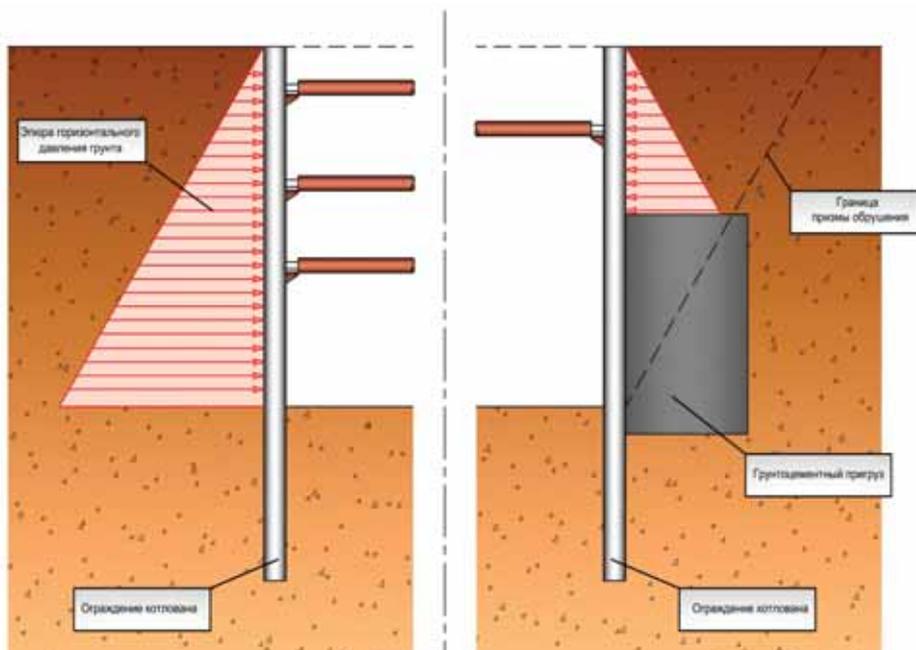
Повышение устойчивости котлована за счет закрепления грунта
